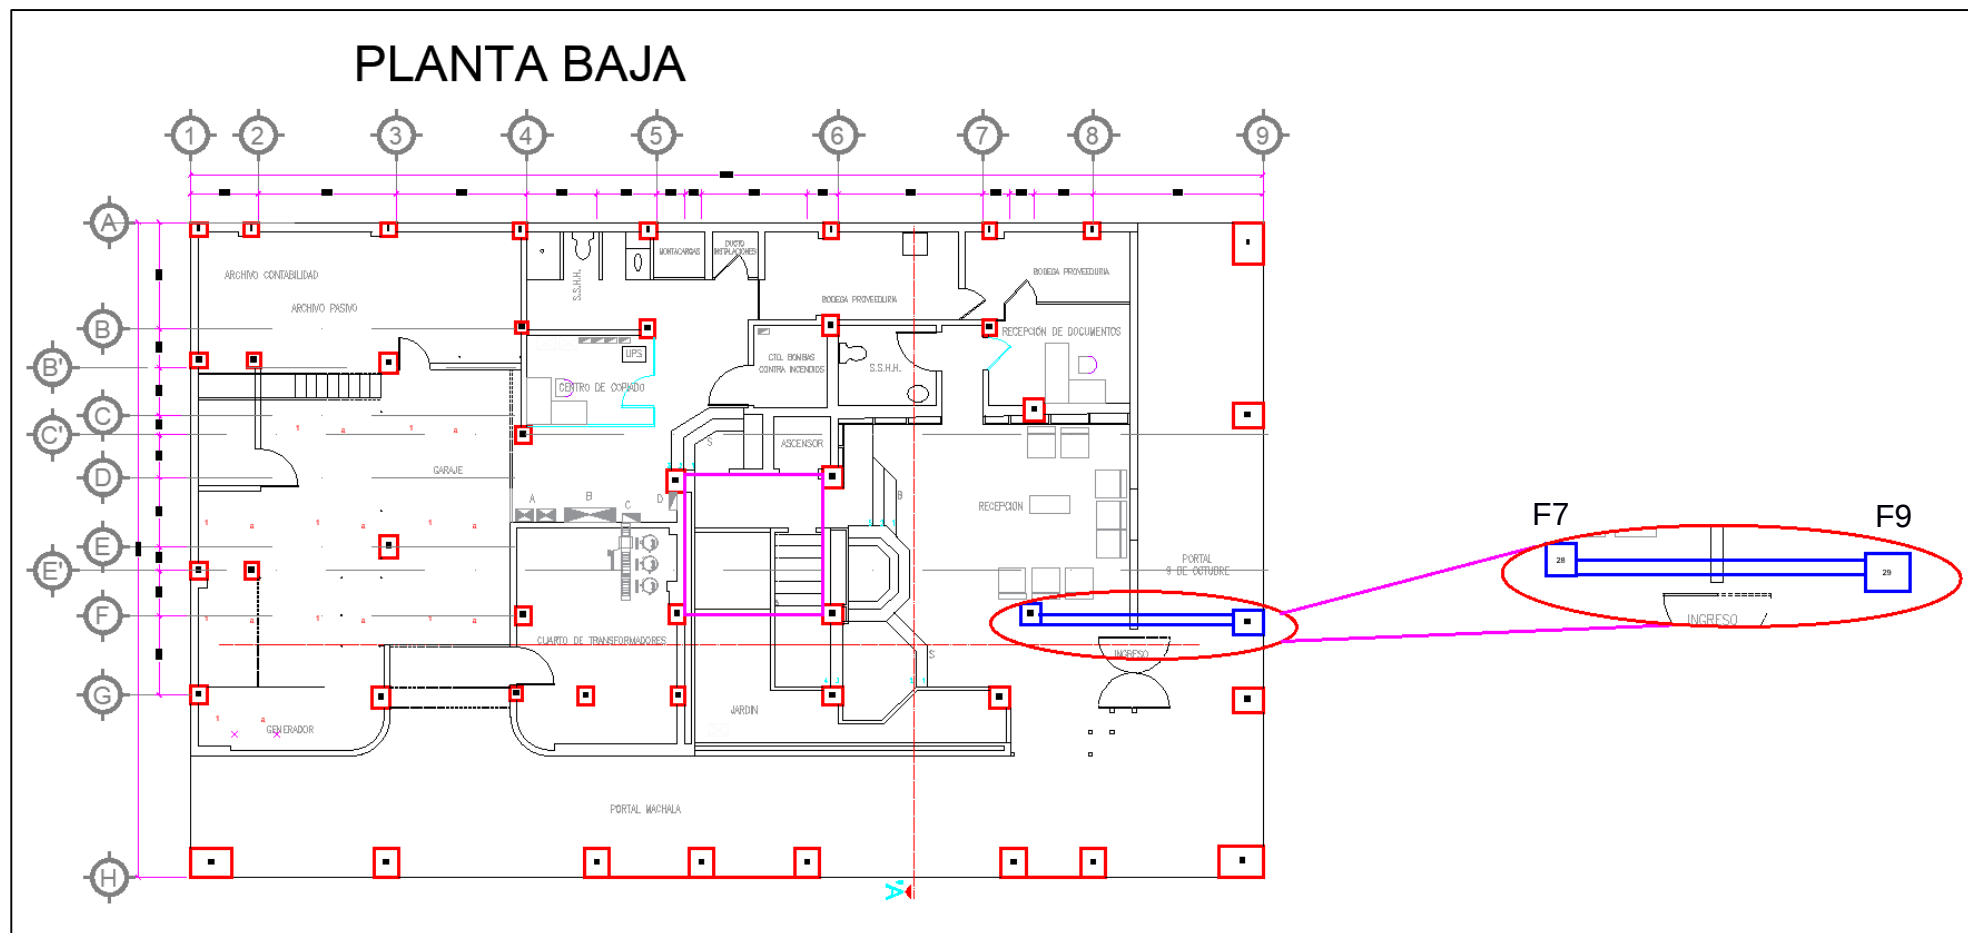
Pórtico Seleccionado, Viga Y Columnas F7 y F9 en planta baja.
